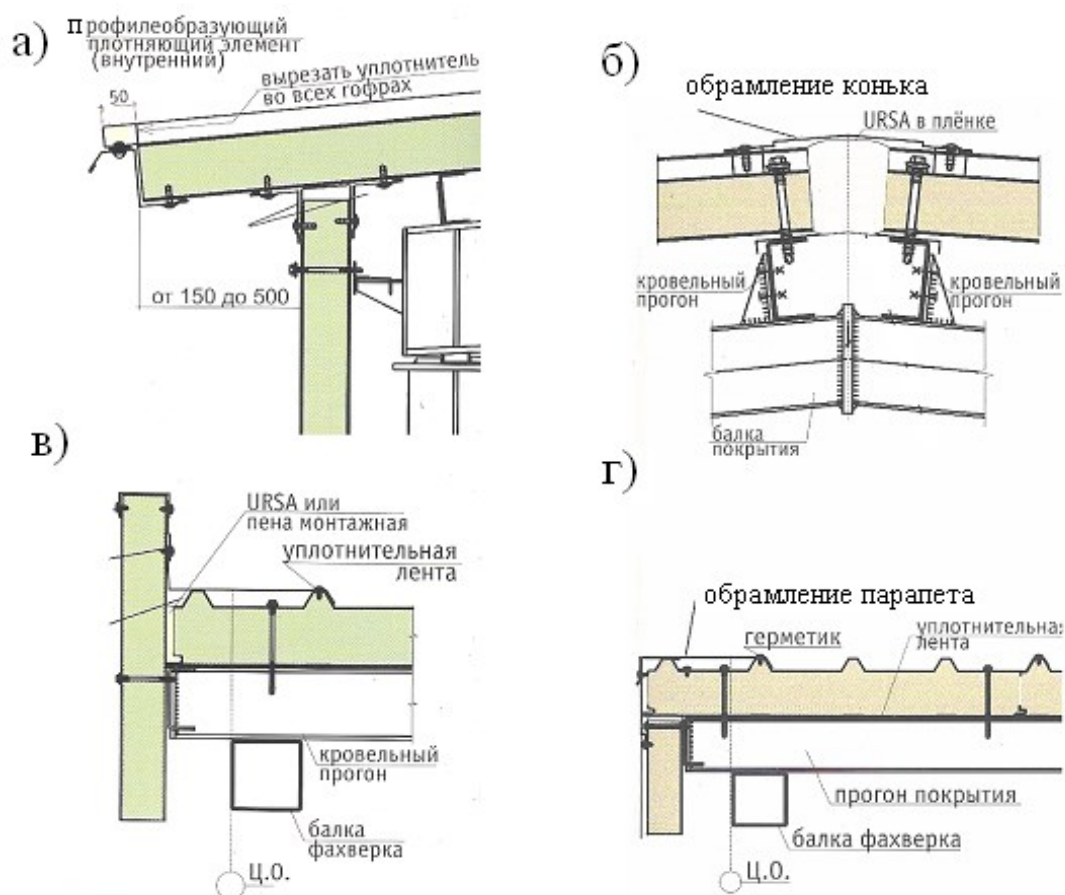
Узлы сопряжения стеновых и кровельных сэндвич-панелей:
